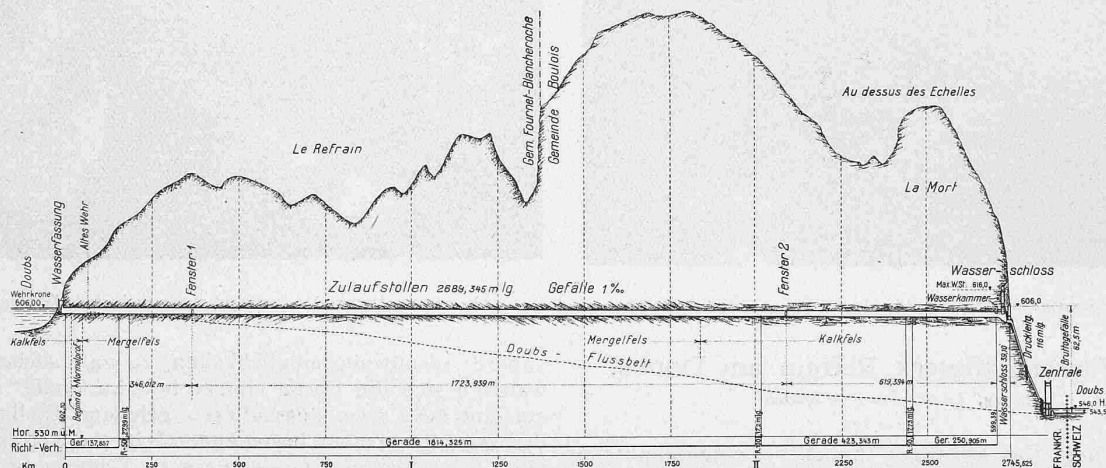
Längenprofil der ausgenützten Gefällsstrecke. — Masstab für die Längen 1 : 20000, für die Höhen 1 : 4000.
